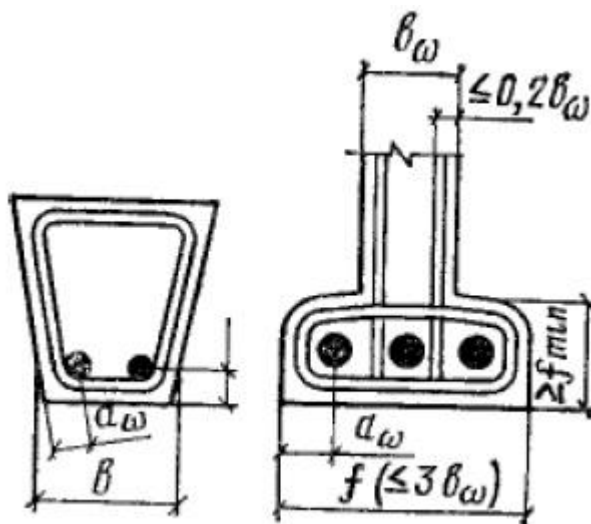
Армирование балок и расстояния до оси арматуры
